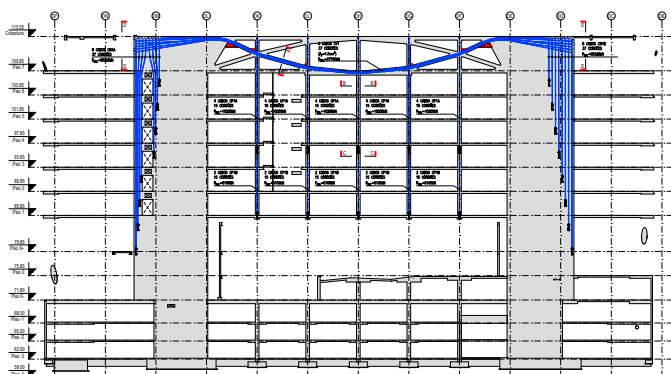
Pré-esforço da viga de transição 1 (45 m vão) (funicular e anti-funicular das cargas). Prestress of transfer beam 1 (45 m span).
